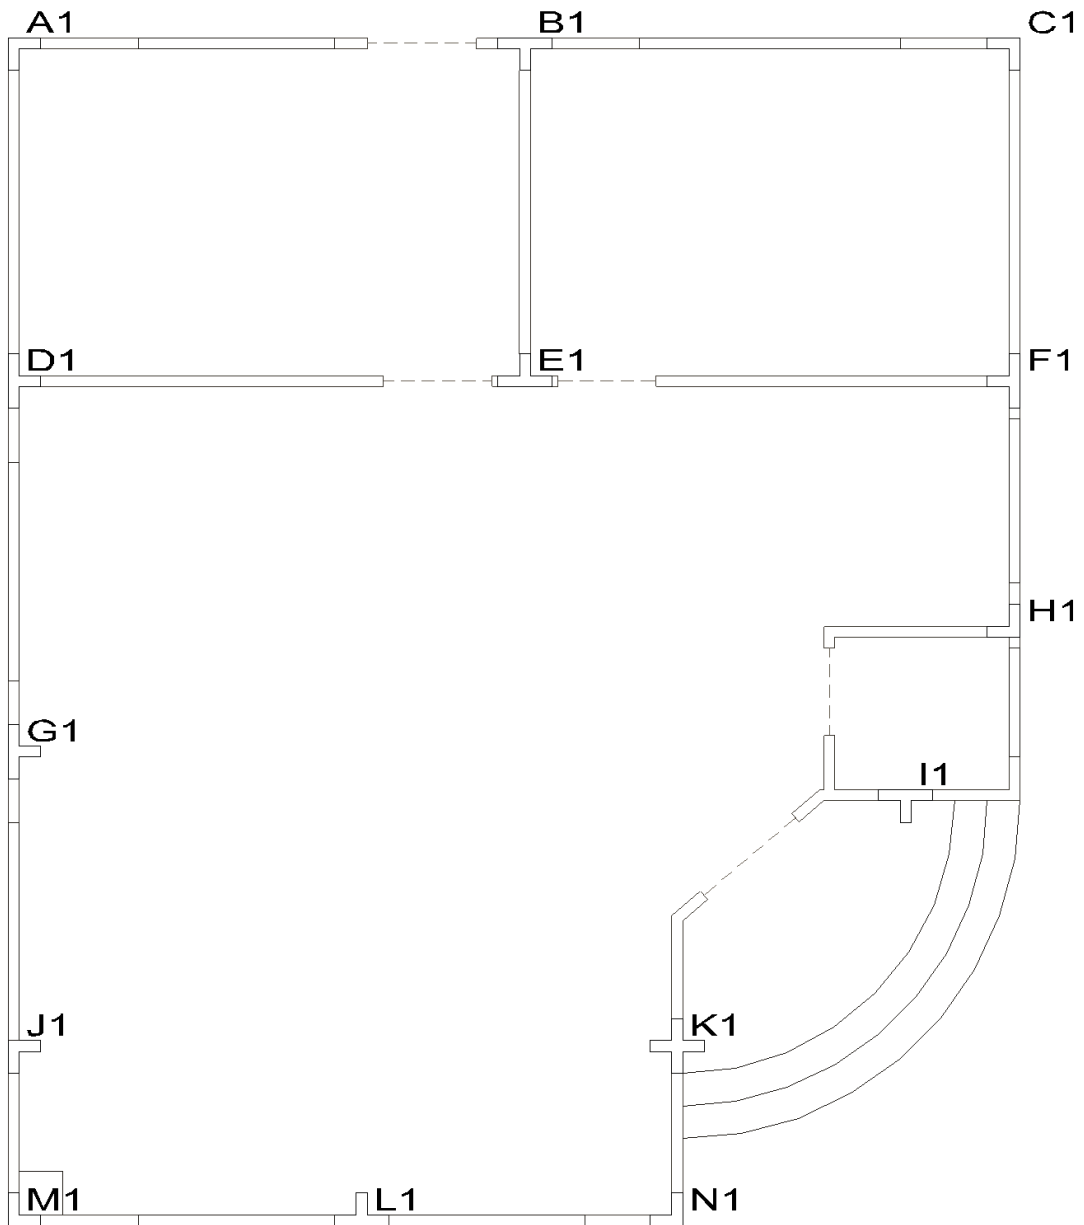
Ubicación de seudo columnas a reforzarse en los N+2.70m
